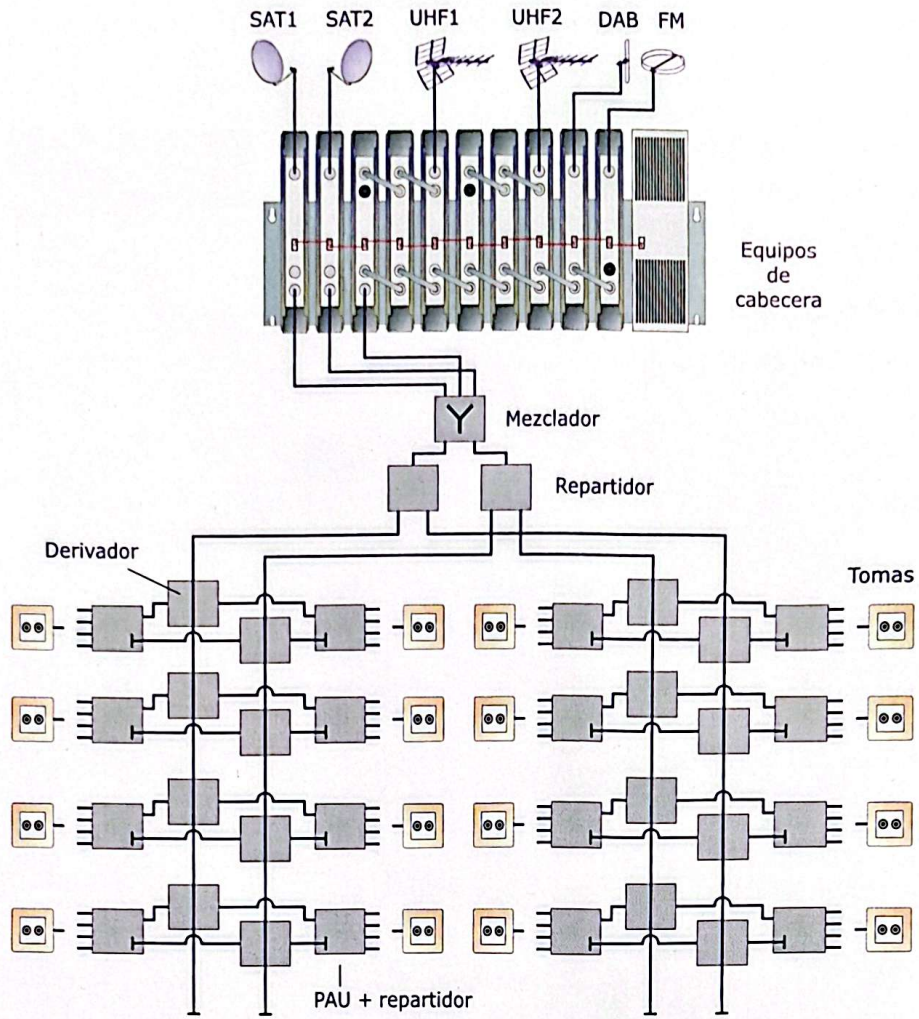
Instalación colectiva vertical con dos bajantes y SAT.
